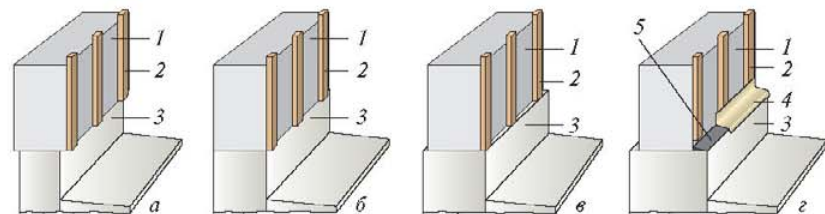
Виды цоколей: а — западающий; б — ровный; в — выступающий (выровненный обрешеткой со стеной); г — выступающий с отливом поверх обрешетки; 1 — стена; 2 — обрешетка; 3 — цоколь; 4 — виниловый отлив Дёске; 5 — цементная стяжка
